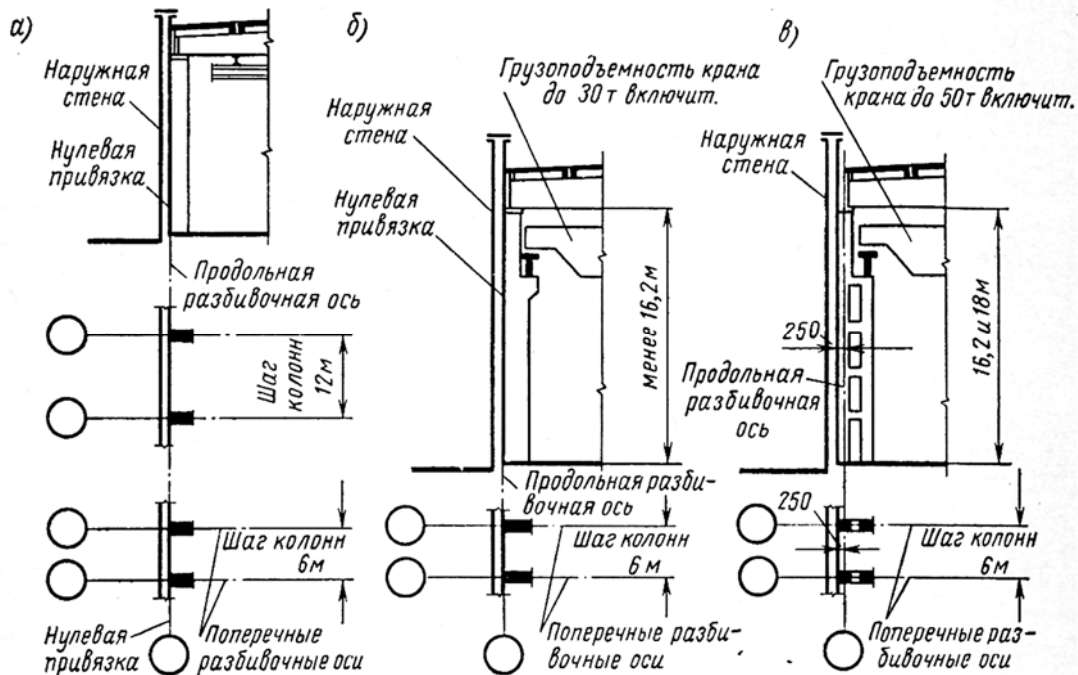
Привязка колонн крайних рядов и наружных стен к продольным разбивочным осям здания:
